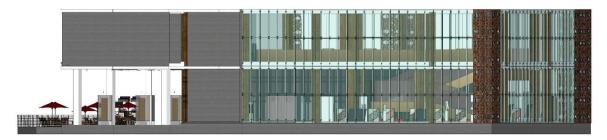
Tampak Samping Kanan Bangunan Pameran A
